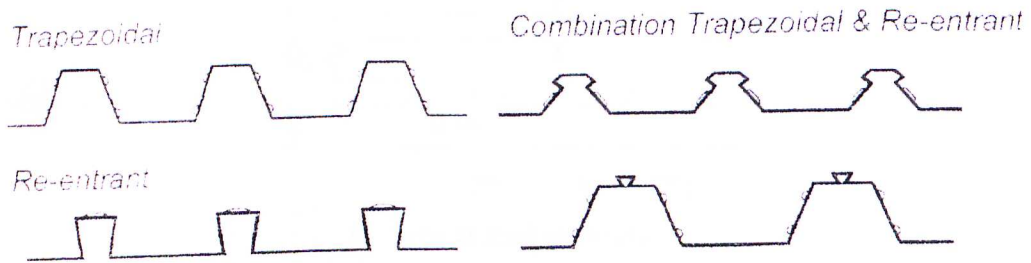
Tipos de fôrmas de aço utilizadas nas lajes Mistas [Schuurman, 2001]
